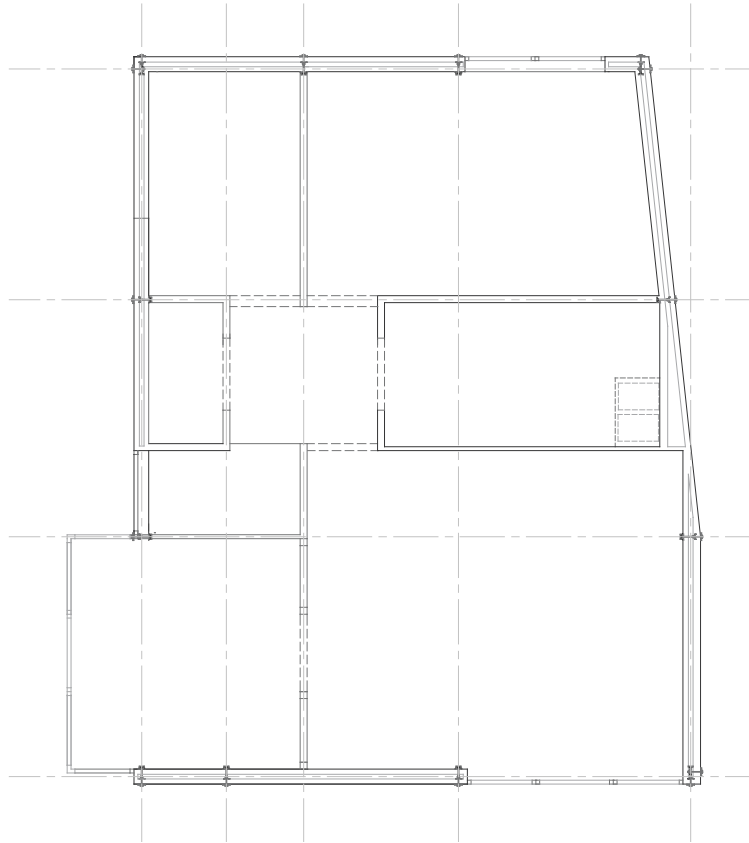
Planta superior con ubicación de anclajes de paneles a pilares.
